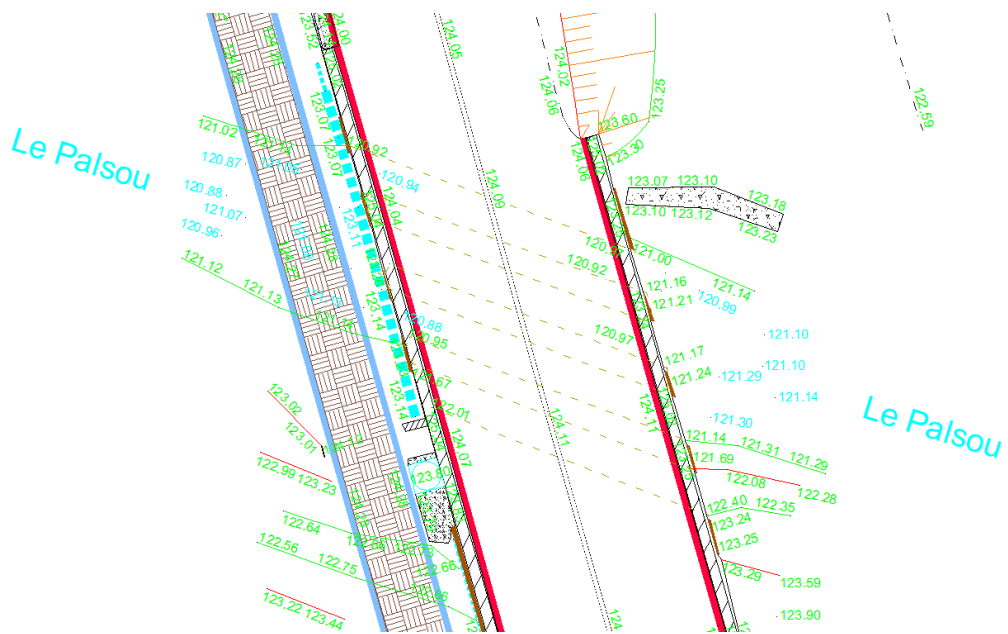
Plan topographique du pont de la RD20 (état actuel), source : Département du Lot
